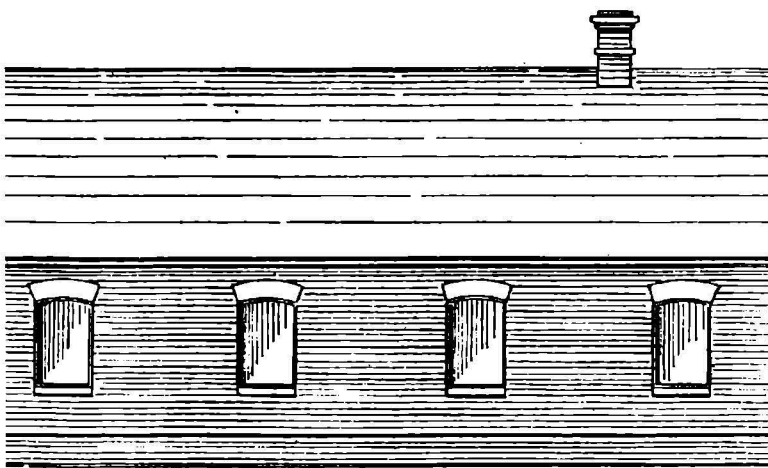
Detail des Planes zur Erbauung eines Arbeiterwohnhauses
